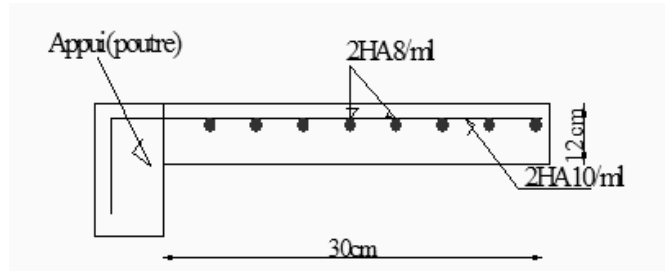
schéma de ferrailage de la dalle sur 2 appuis.
